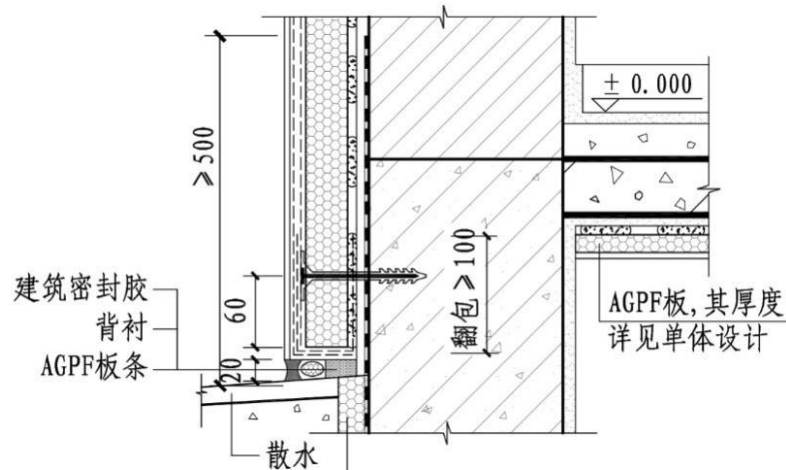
有地下室勒脚部位外保温构造示意图
